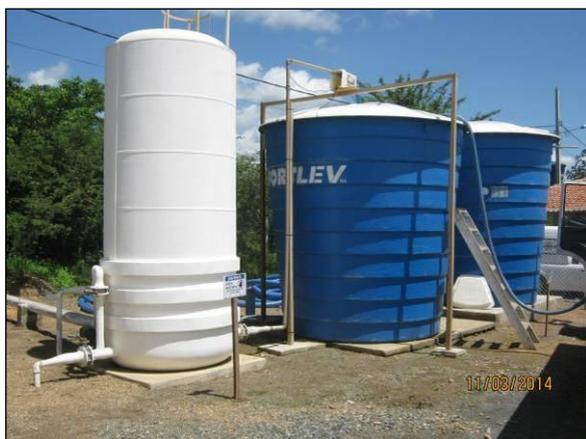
Poço tubular profundo implantado no canteiro central (antigo Lote 07), com sistema de cloração e armazenamento adequados (mar/2014).
